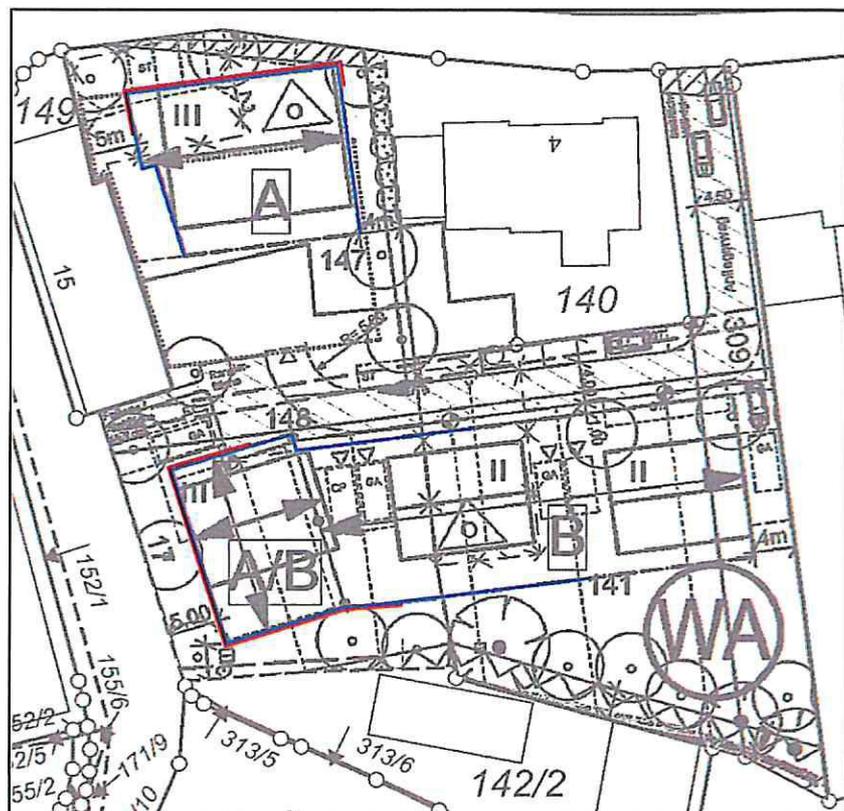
Kennzeichnung der Fassadenbereiche im Erdgeschoss
